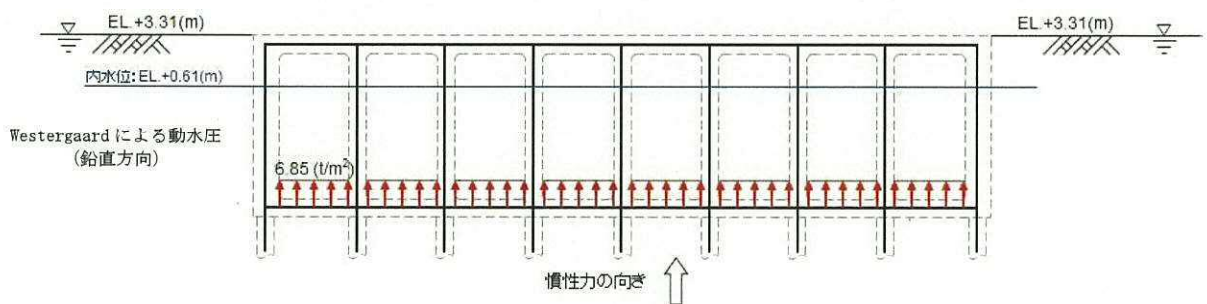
(2) 鉛直動による動水圧図 (①—①断面)
